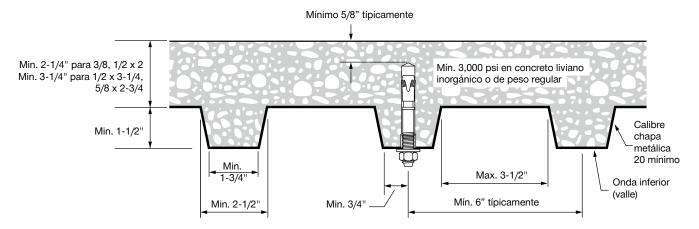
Instalación de Kwik Bolt VTZ sobre concreto liviano inorgánico en el piso de una chapa metálica en losa compuesta
